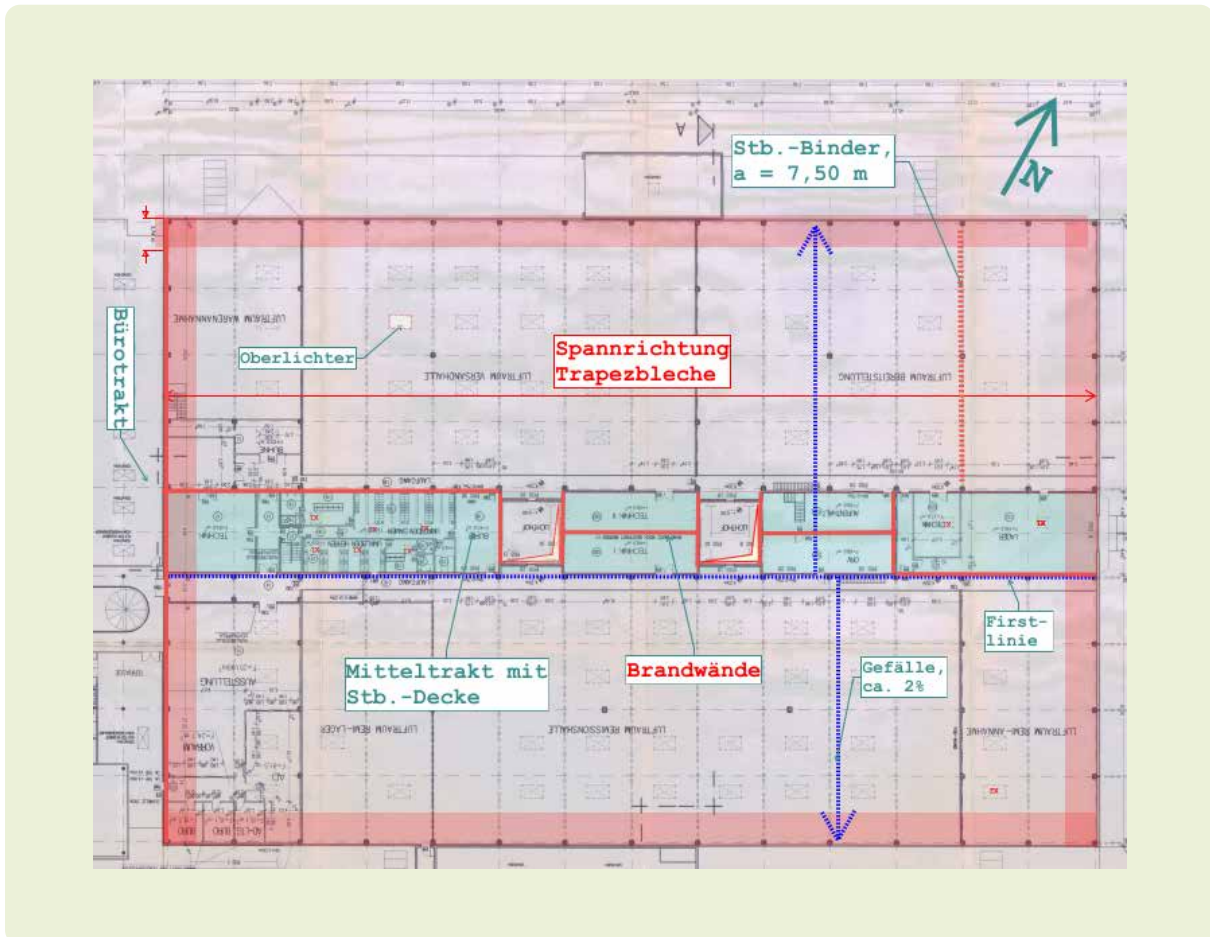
Grundriss Hallenteil (Bauzeichnung 1998 mit Ergänzungen)
